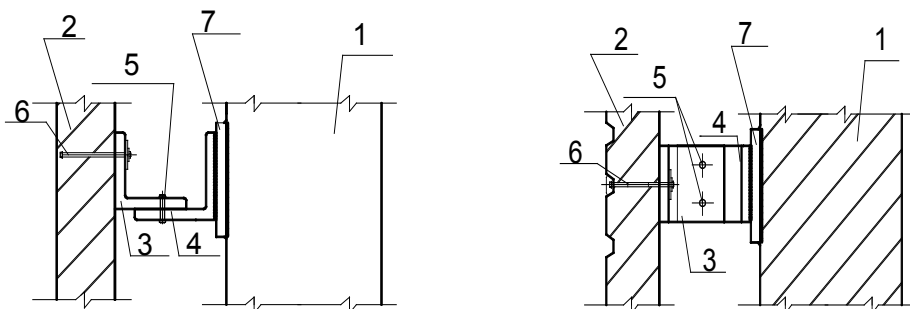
Узел крепления несущей колонны здания со стеновой панелью: 1-железобетонная колонна; 2 — стеновая панель; 3 и 4 — стальные уголки; 5 — срезные болты; 6 — анкерные болты; 7 — закладная деталь
